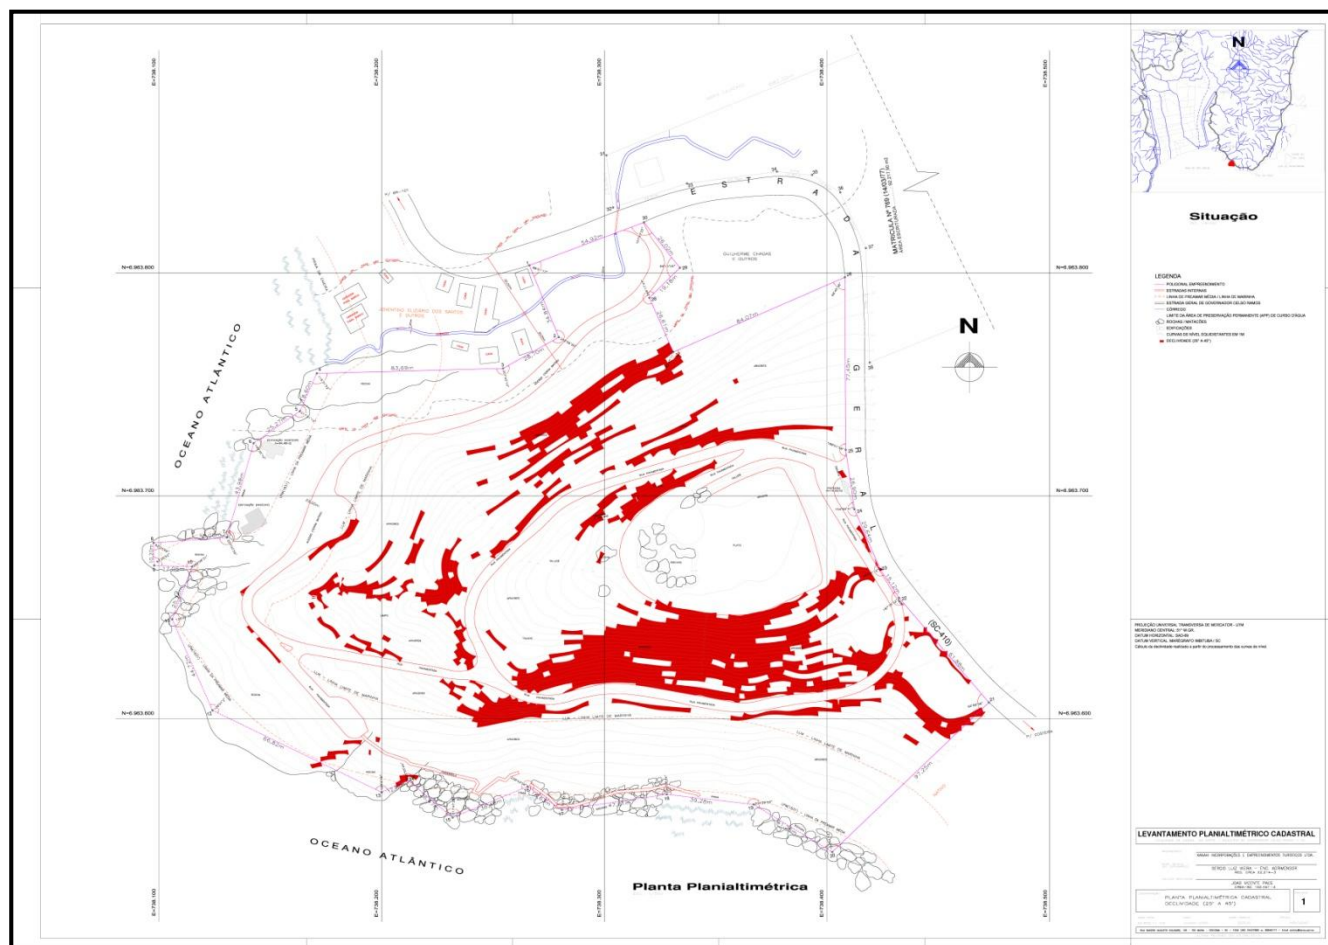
Recorte da Planta de Declividade da gleba onde pretende-se implantar o resort, onde na cor vermelha as manchas com declividade entre 25° e 45°.
